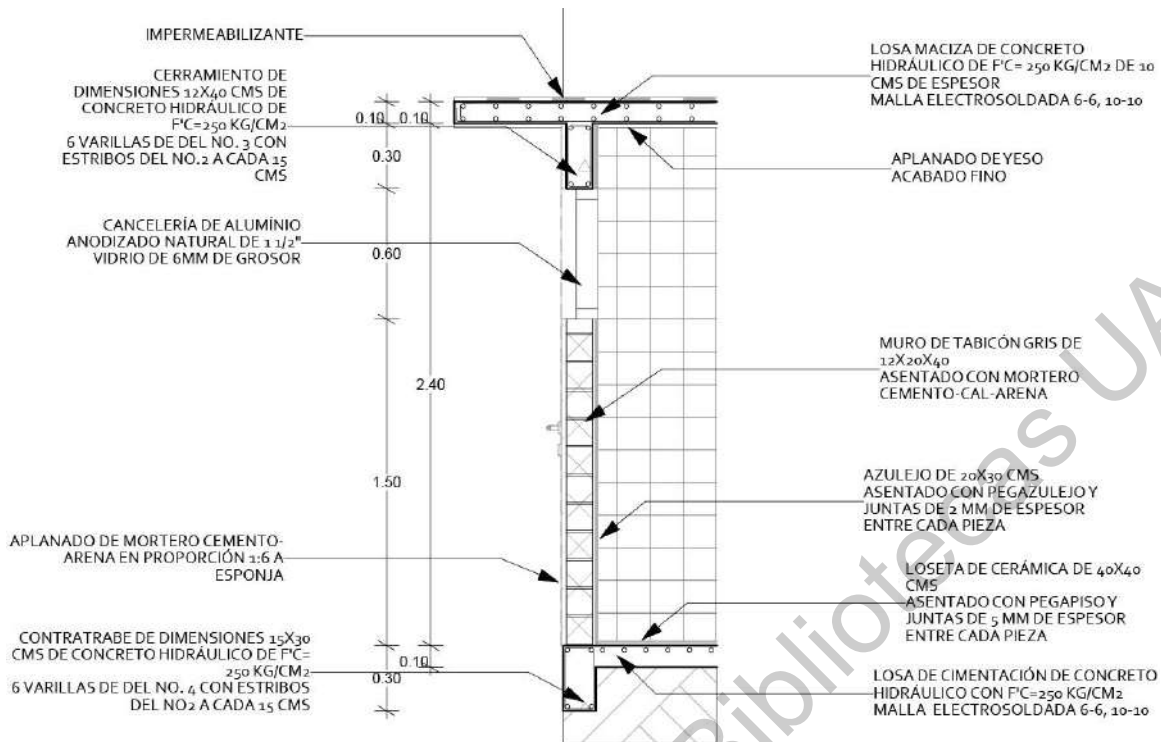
Corte por fachada de muro del baño. Elaboración propia.
